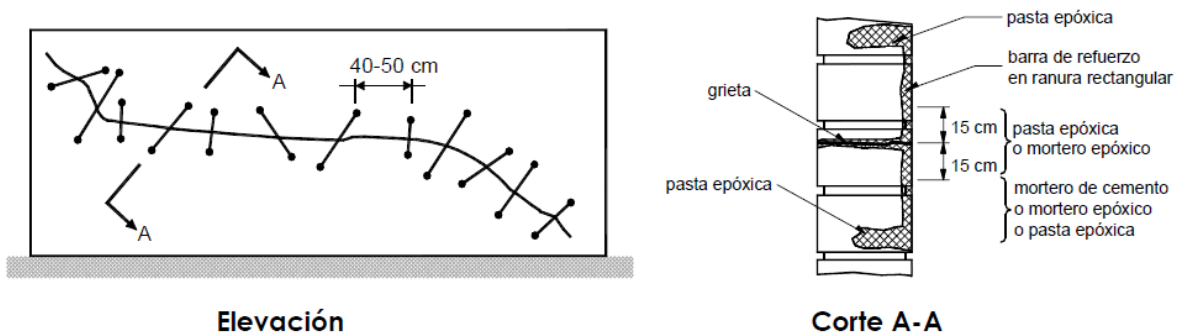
Colocación de grapas sobre grietas en muros de mampostería (Alcocer, 2003).
